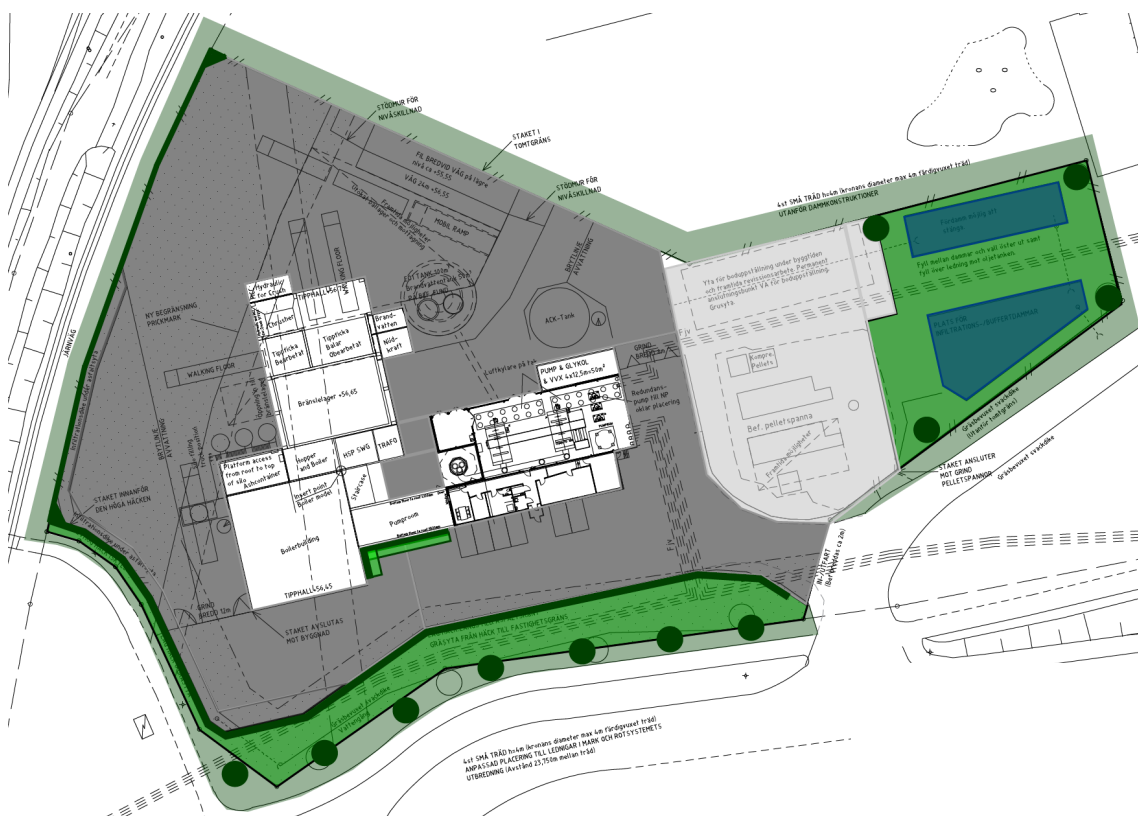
Föreslagen situationsplan med grönyta och hårdgjord yta. (se även separat bilaga)
